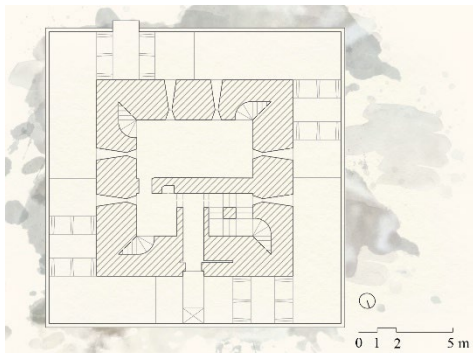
Isola di Santo Stefano, Arcipelago di La Maddalena, pianta del piano terra della Torreforte (elaborazione grafica di Elisa Alberta Bianchi, 2024).
